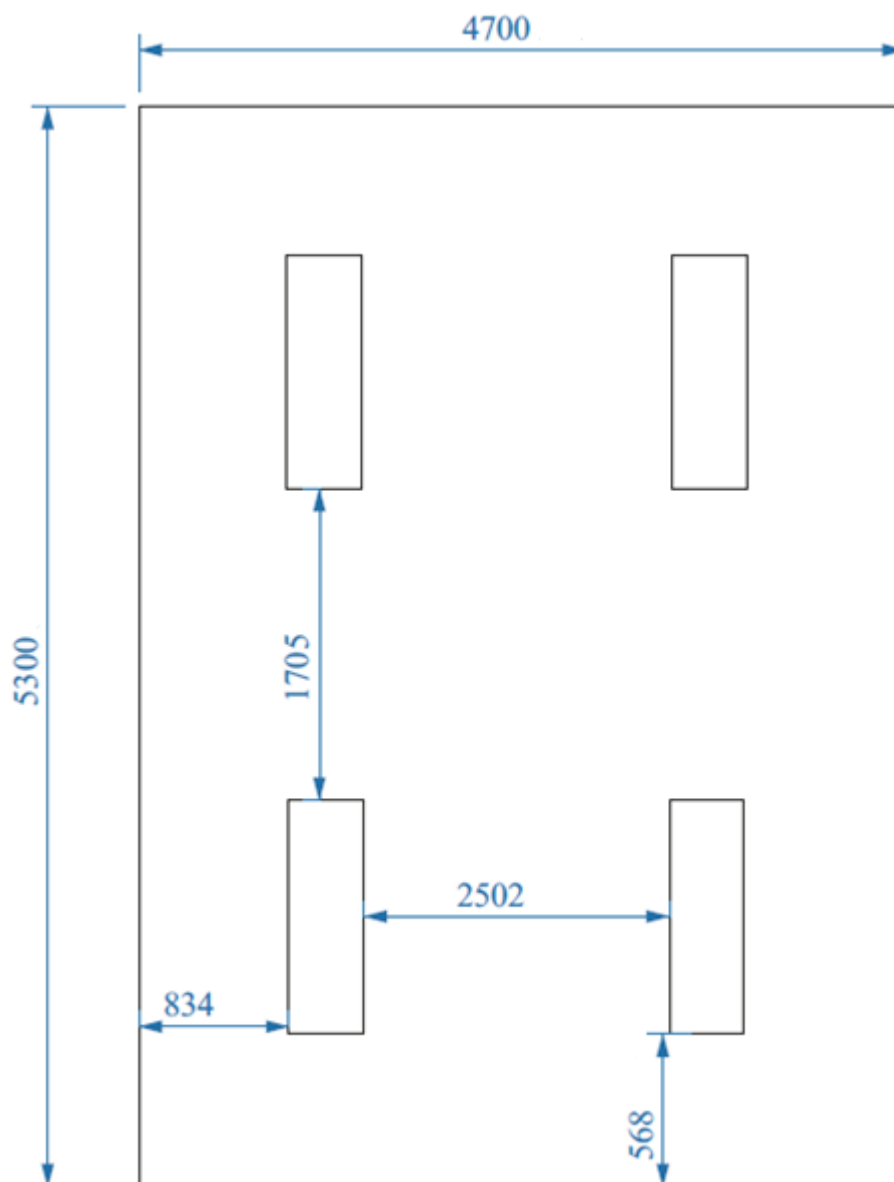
План помещения и размещения светильников с люминесцентными лампами
